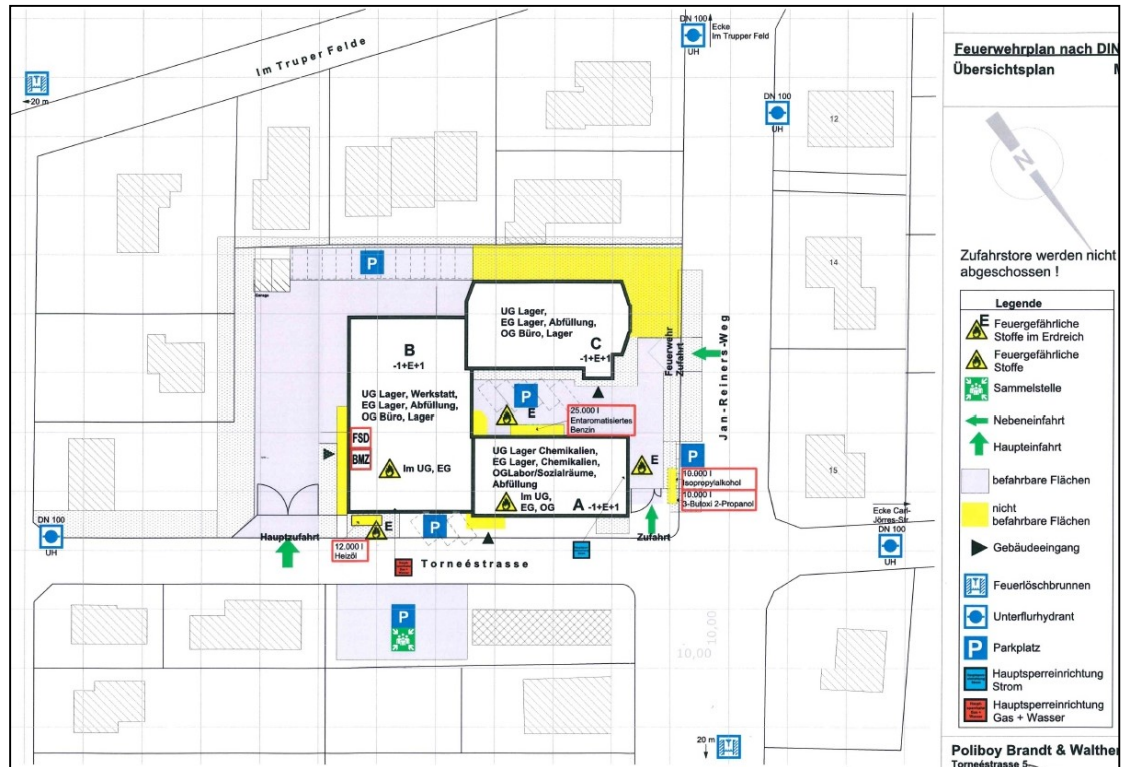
Feuerwehrplan nach DIN 14095 für die Poliboy Brandt & Walther GmbH (S3 Bremen, Stand: 20.11.2014)
